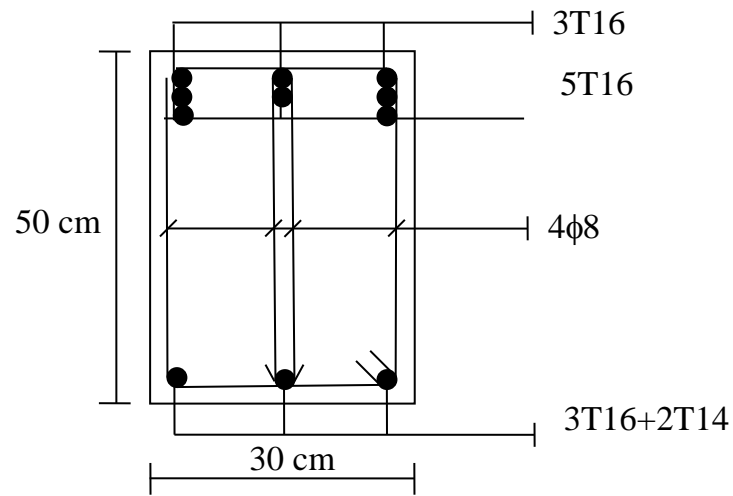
Schéma de ferrailage de la poutre principale (Appuis)
